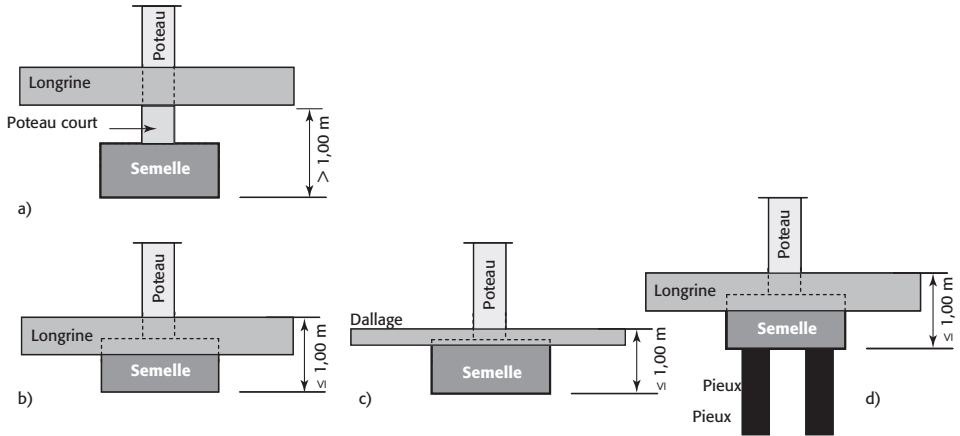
Liaisons entre fondations : a) Interdiction des poteaux courts dans les fondations b) Disposition de la longrine par rapport à la semelle c) Disposition du dallage par rapport à la semelle d) Cas de semelle sur longrine
